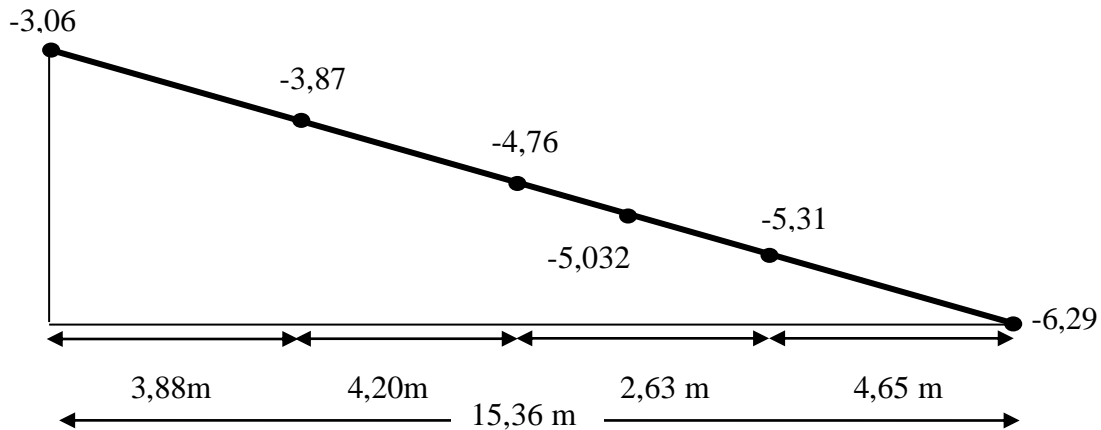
Coupe transversale de la rampe d'accès des deux sous-sols.
